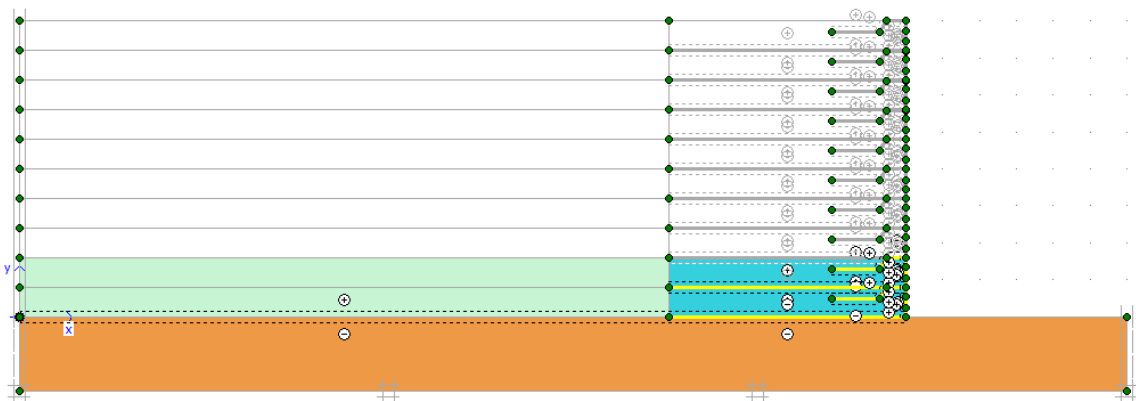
Estágio de cálculo após da construção da camada 2.
